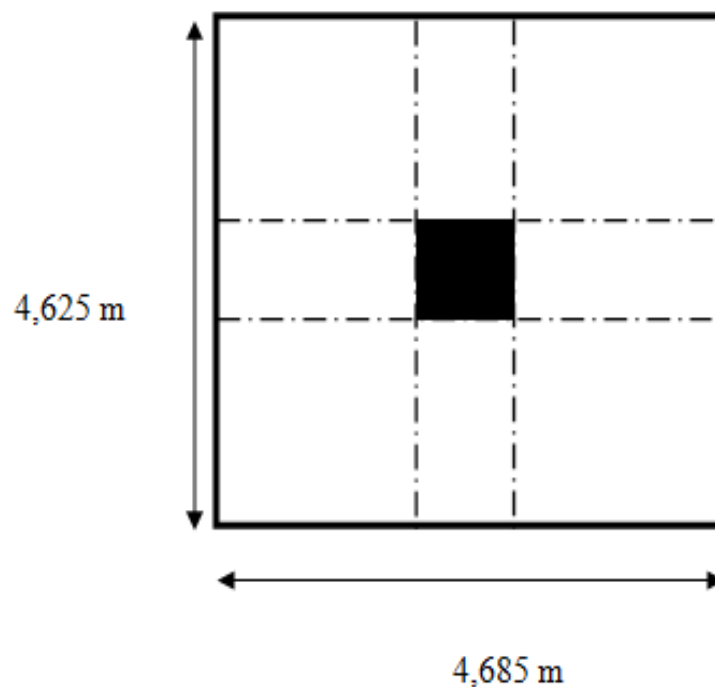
Vue en plan de poteau central le plus sollicités
